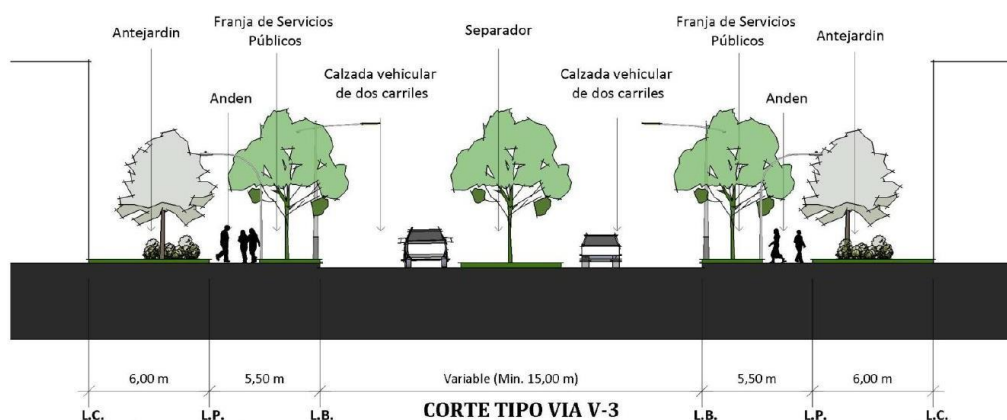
Sección típica perfil V-3. Fuente: POT Barranquilla.
